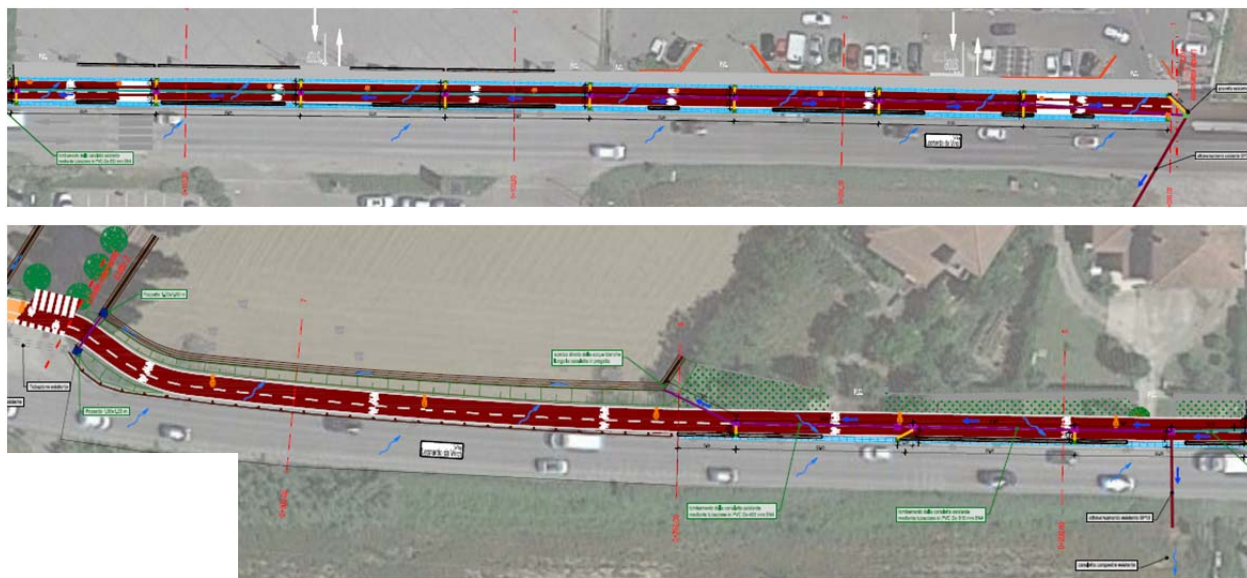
Estratto planimetria di sistemazione idraulica – Lotto 2
